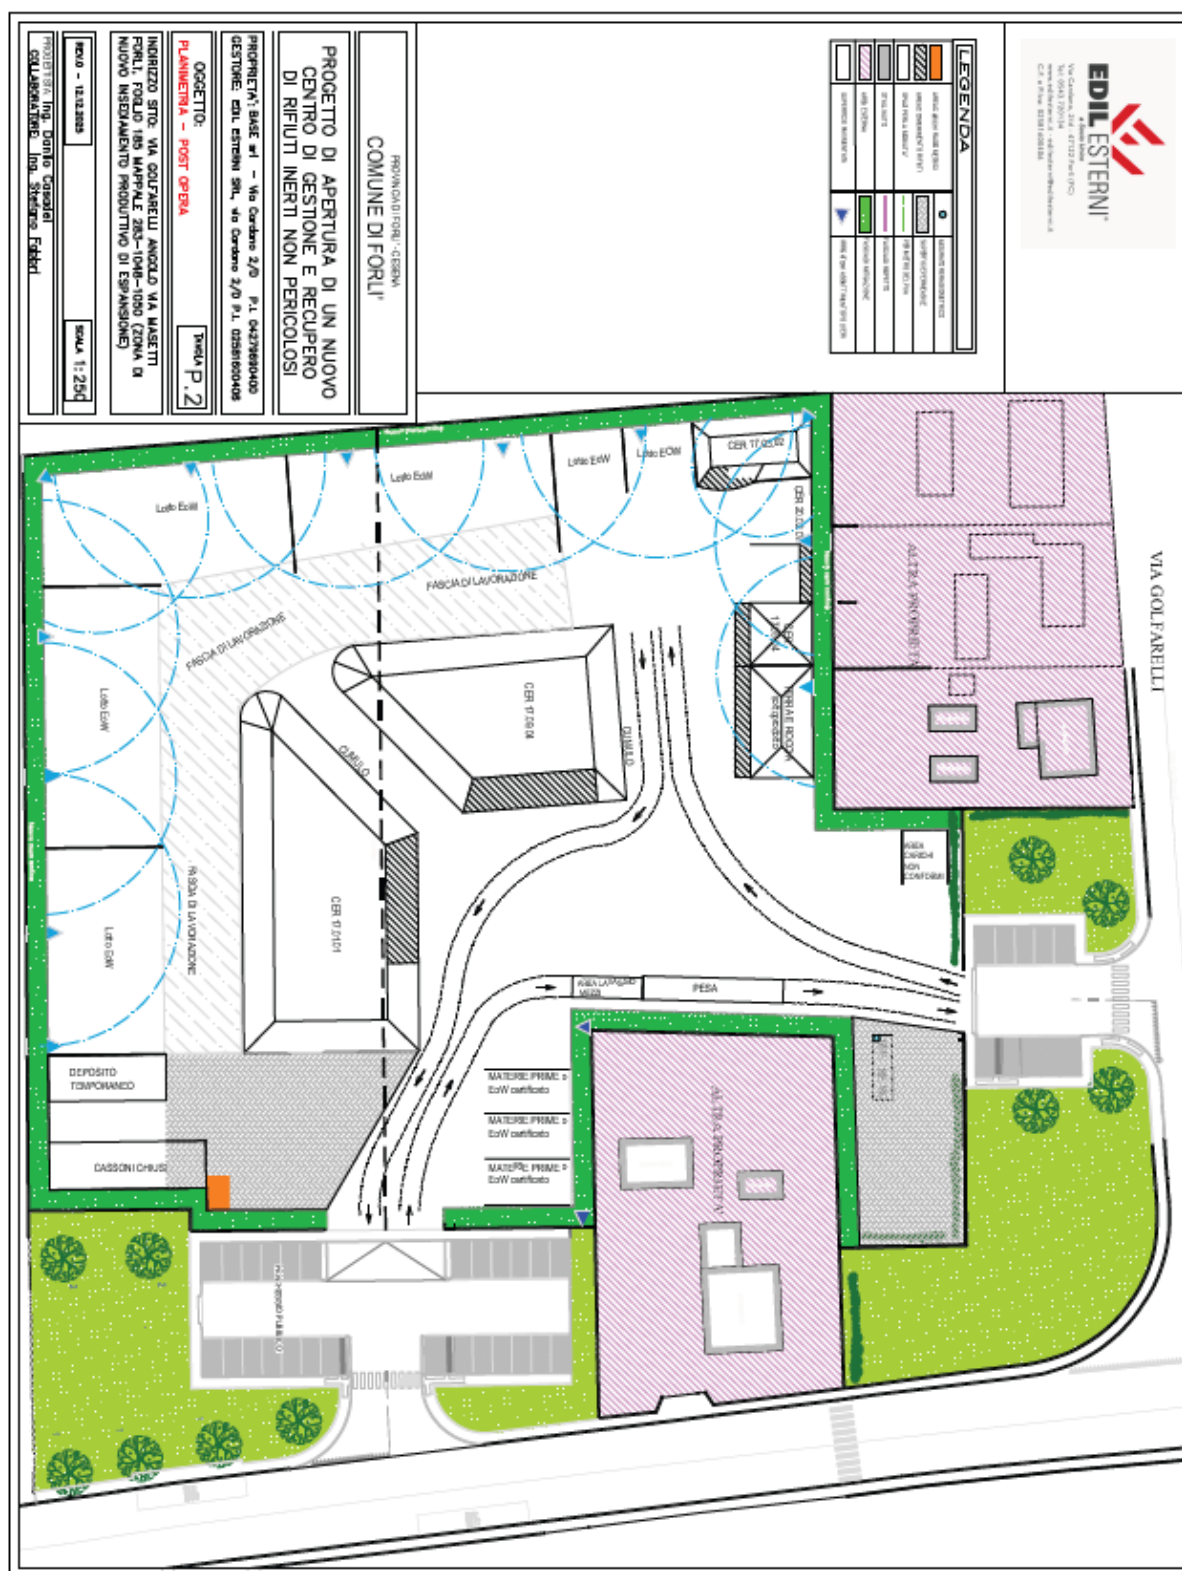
\_20 Planimetria di progetto POST-OPERAM
